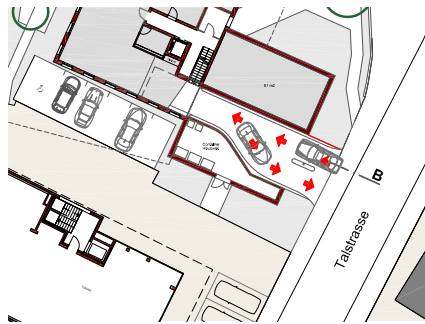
Einstellhalleneinfahrt Variante A, Ducksch Anliker Architekten, März 2017
